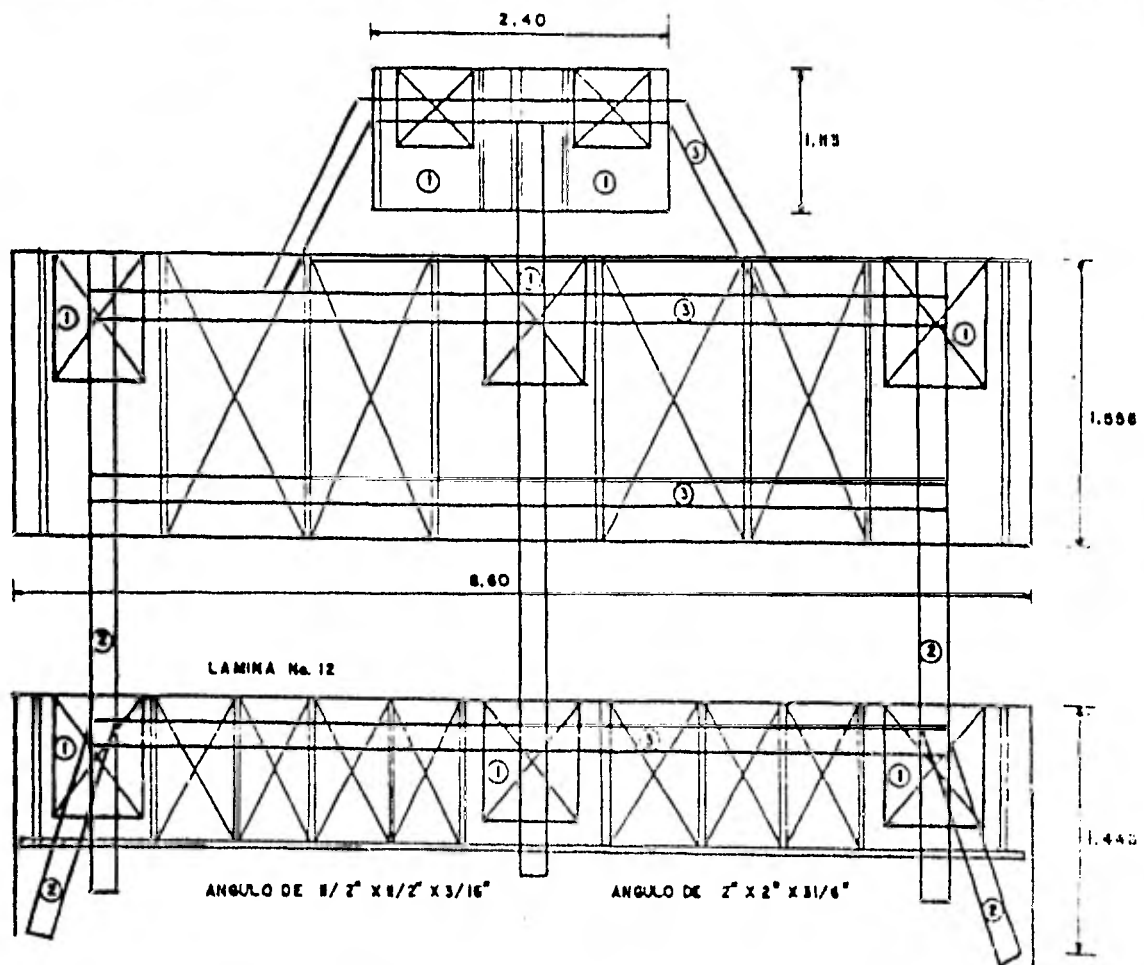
DISTRIBUCION DE VIGUETAS DE APOYO Y GATOS HIDRAULICOS
